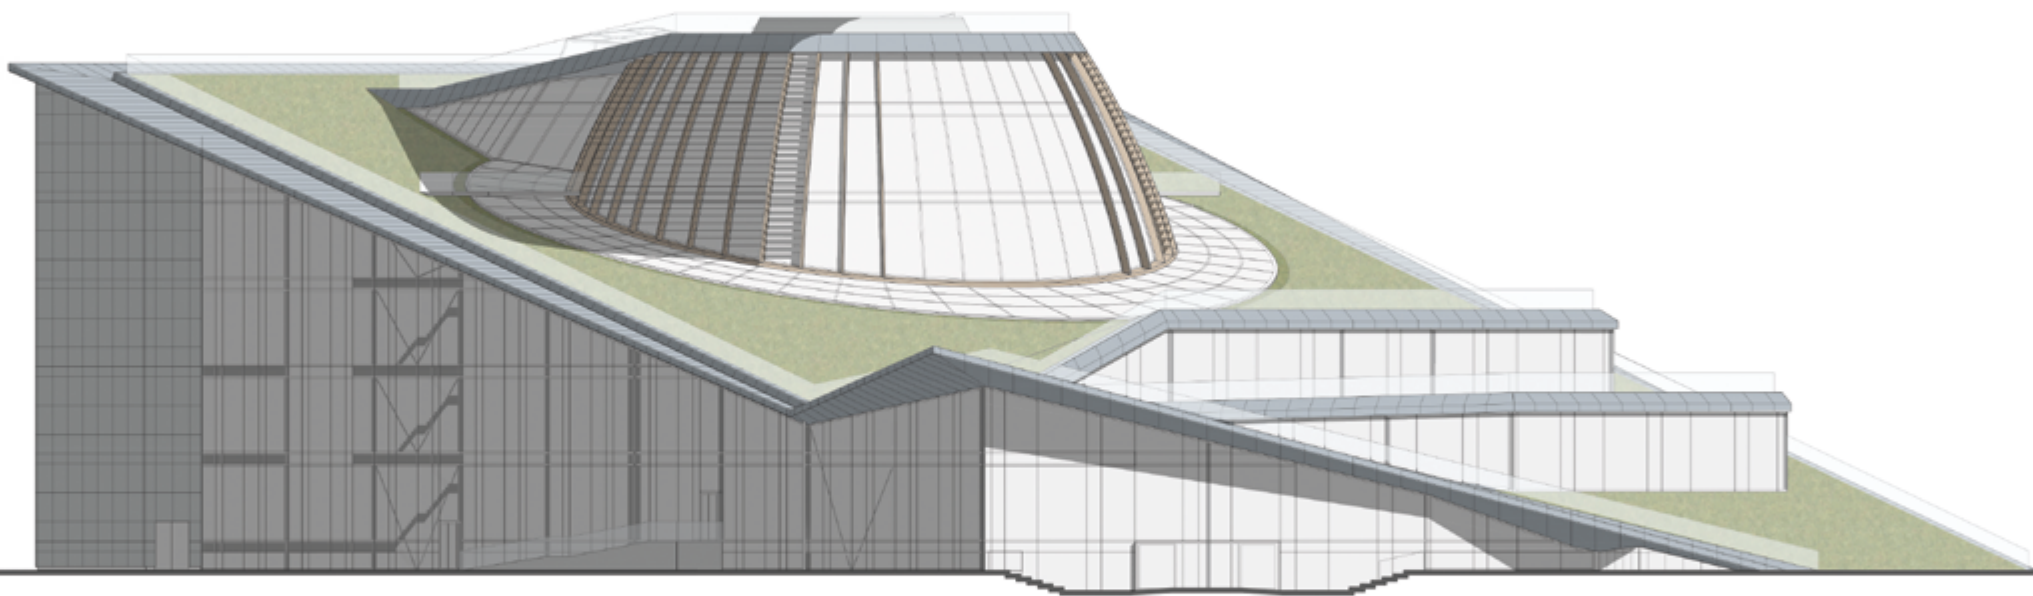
VISTA DALLA SPONDA OPPOSTA DEL TAMIGI
